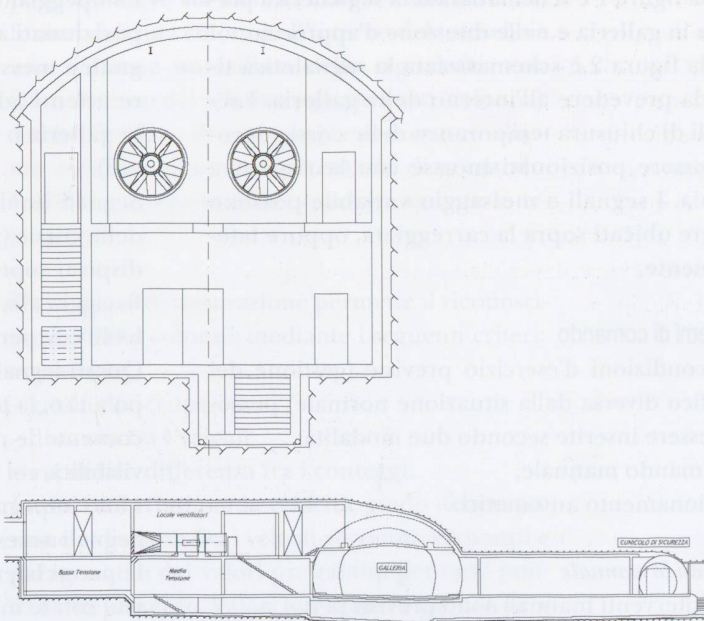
Sezione trasversale e longitudinale della centrale di ventilazione intermedia
